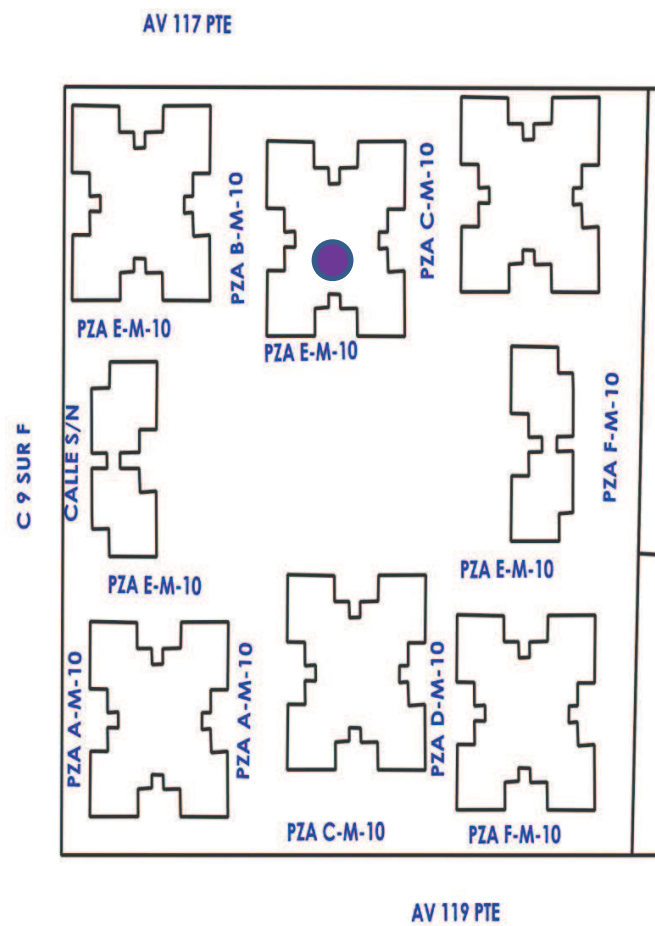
Plano de conjunto de viviendas 2. Por: VRA, 2014
